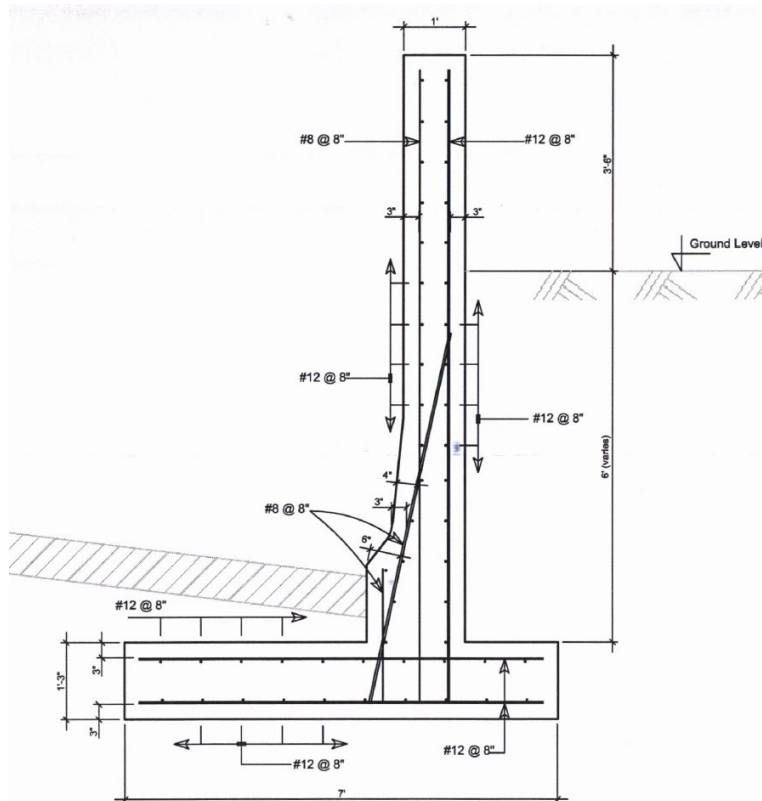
Bewehrungsplan der Stützmauer mit Basaltfaser-Bewehrungen in Miami, Florida, (USA), aus [63].
